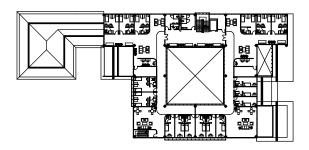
Denah Ground Floor Sumber: Penulis, 2020
